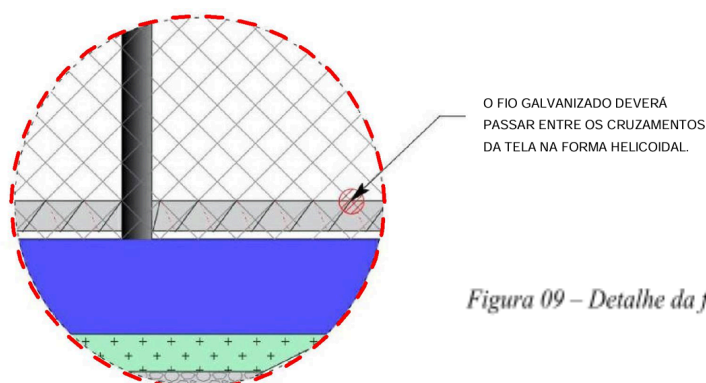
Detalhe da fixação das telas (Fonte: Autor/2024)
